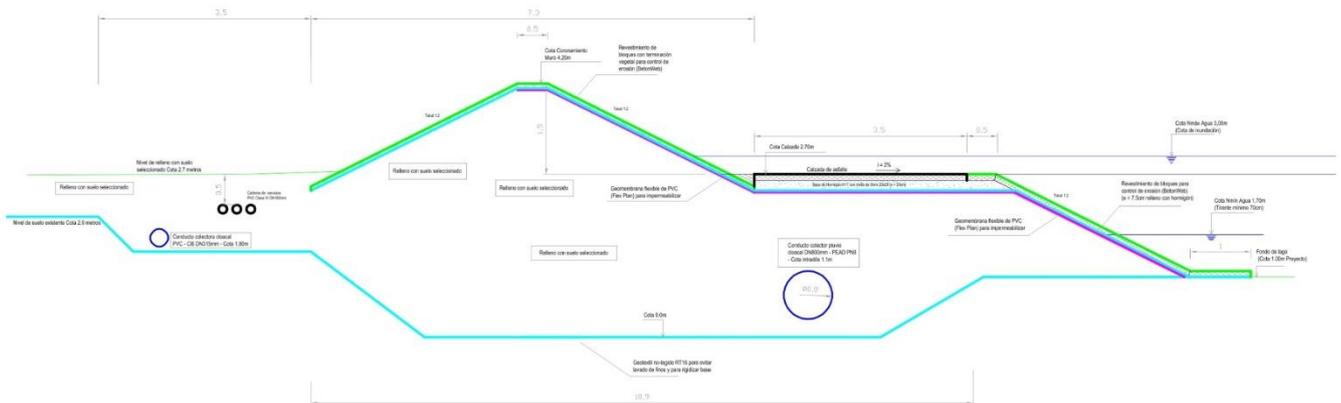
Corte transversal de la estructura de protección contra inundaciones.
